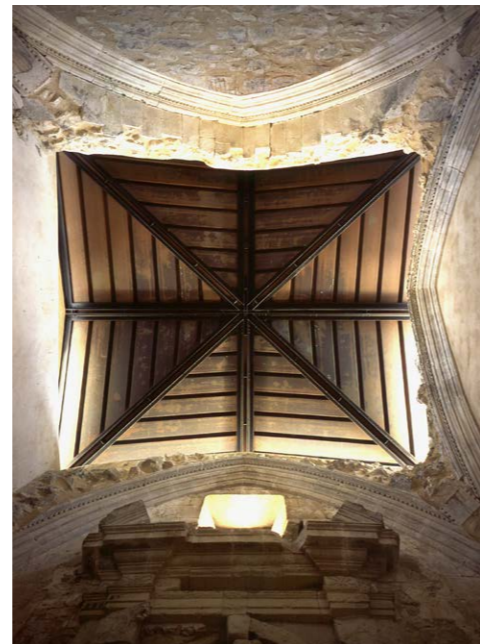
Santa Maria del Gesù, exterior de las capillas hacia la ciudad. Fotografía: Lamberto Rubino. | Figura 2. Santa Maria del Gesù, cubierta de las capillas laterales. Fotografía: Lamberto Rubino.
